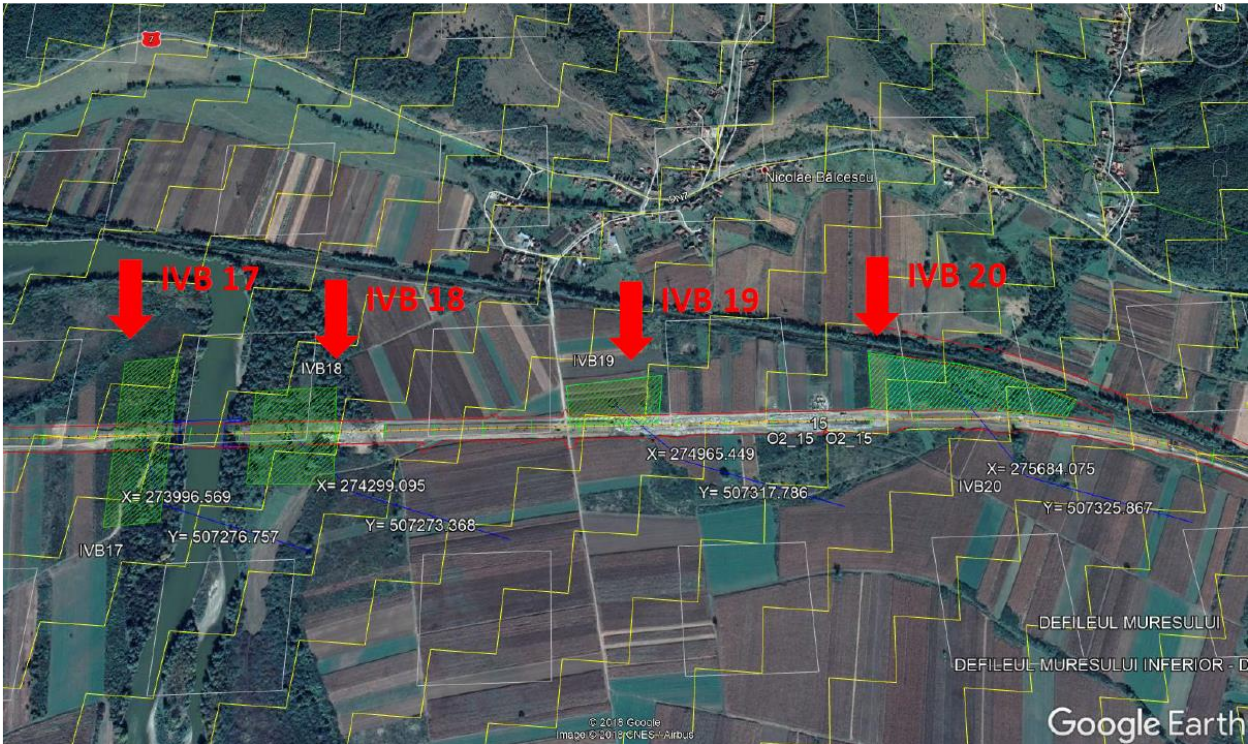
Plan de amplasament pentru platformele IVB 17, IVB 18, IVB 19, IVB 20 – vedere din satelit
